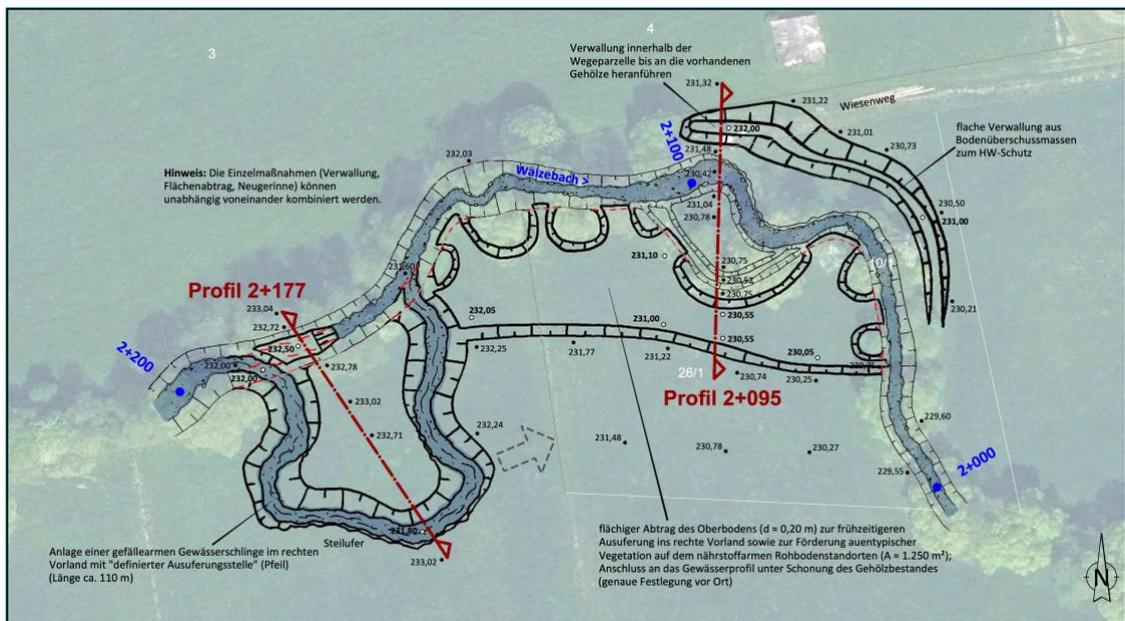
Renaturierungsmaßnahme - Ausschnitt Lageplan/ Profile im Sollzustand (o.M.)
